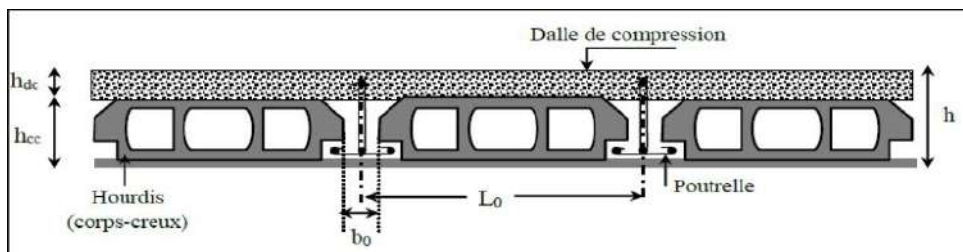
Coupe transversale sur un plancher à corps creux[5]
